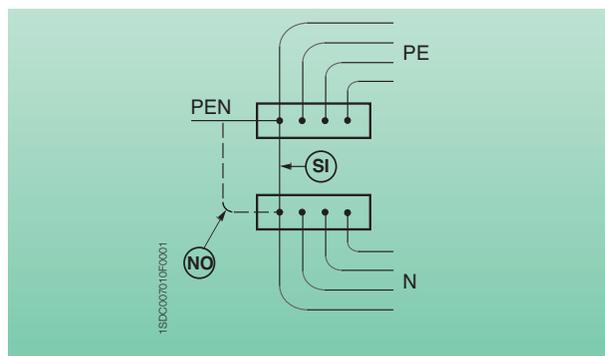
/2 - Collegamento del PEN al giunto di separazione.
